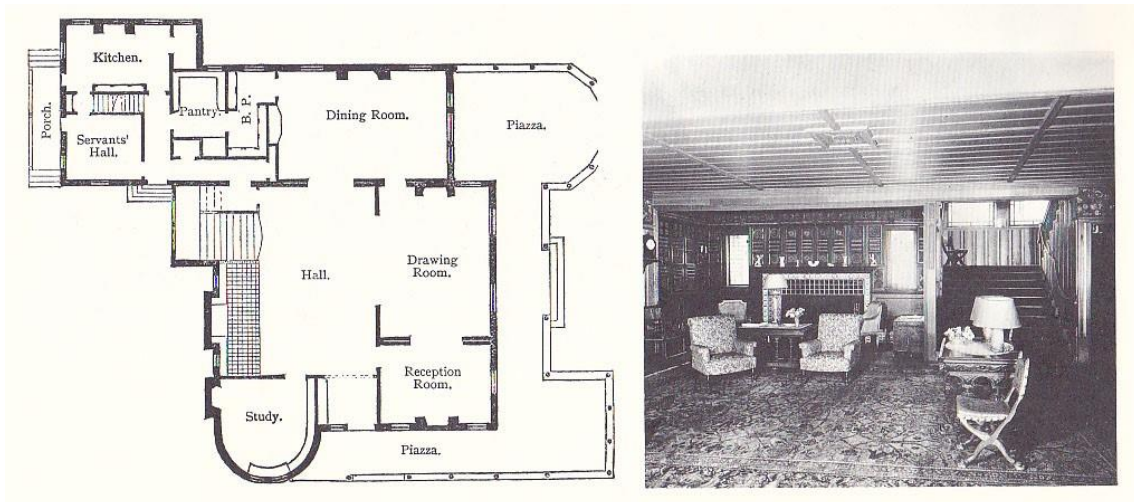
McKim, Mead and White, Casa Isaac Bell, Newport, 1883. Planta (Sheldon) y vista interior de la sala (William King Covell).
